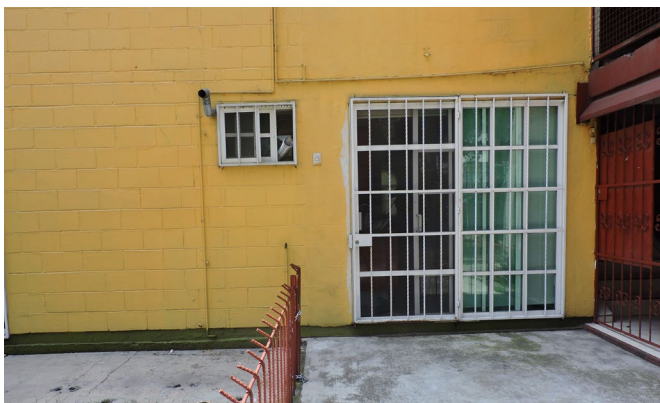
Modificaciones en fachada de edificio tipo B, se observa la apertura de una entrada en donde se encontraba las celosías del patio de servicio, 2018 Fuente: Laboratorio de Vivienda, FA
